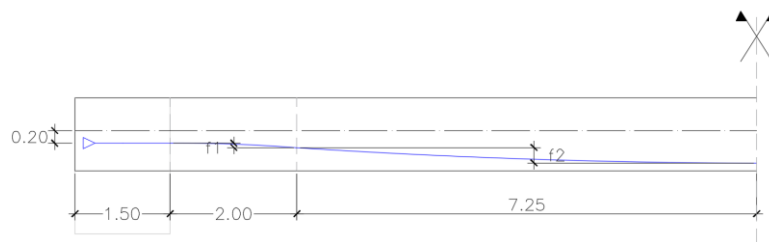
Traçado dos cabos de pré-esforço nas vigas dos alinhamentos B a J.
